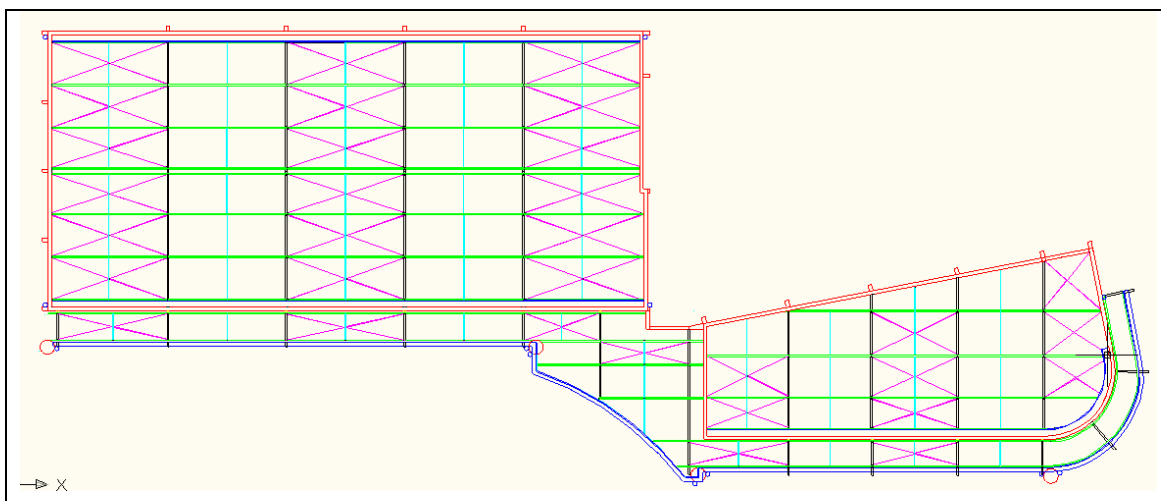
Configuração final da cobertura (melhor visualizado na planta de sistemas XX)
